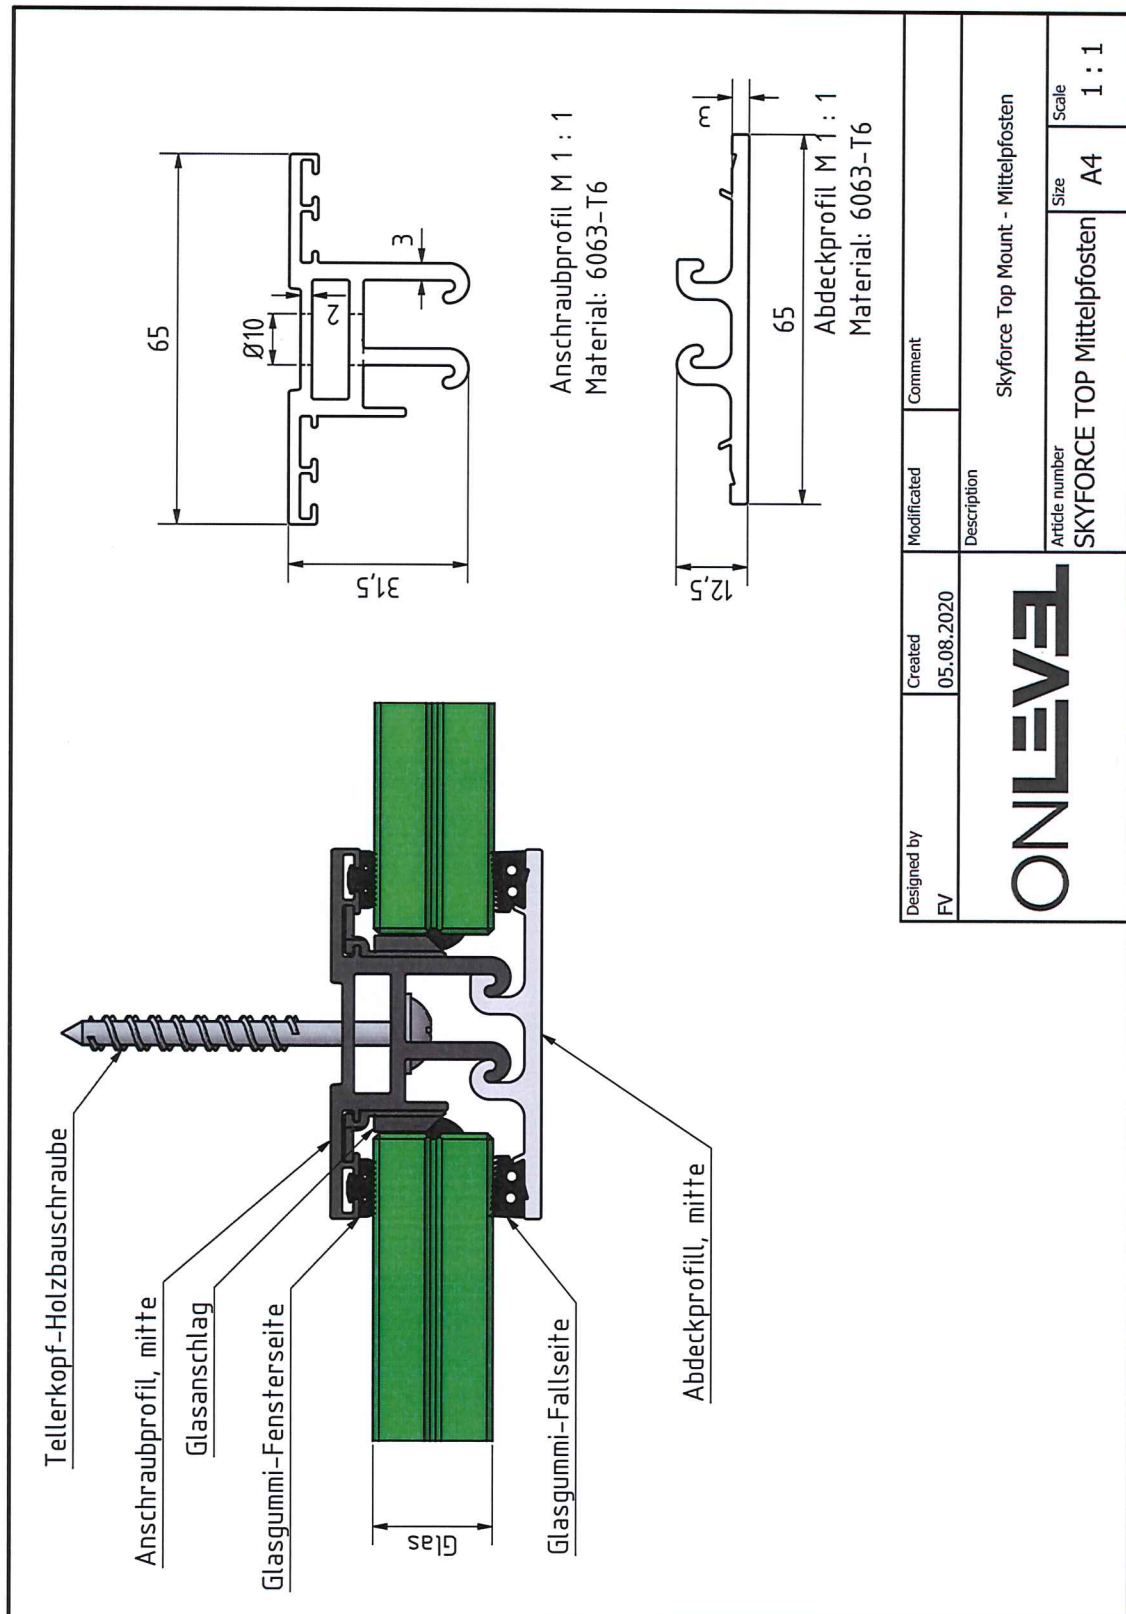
Technische Zeichnung des Auftraggebers – Skyforce Top – Zwischenprofil mit Holzbauschraube
